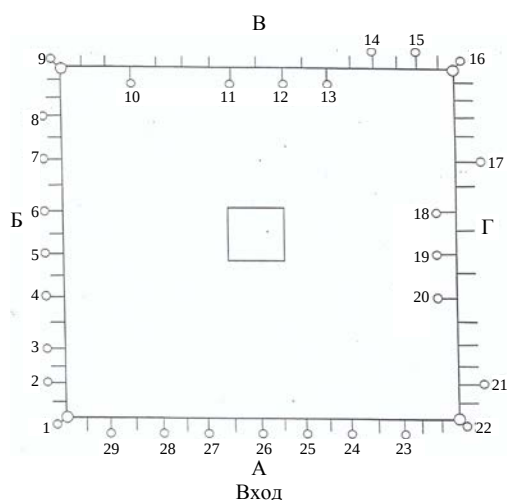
Схема расположения осадочных марок на свайных фундаментах по периметру здания рынка:
